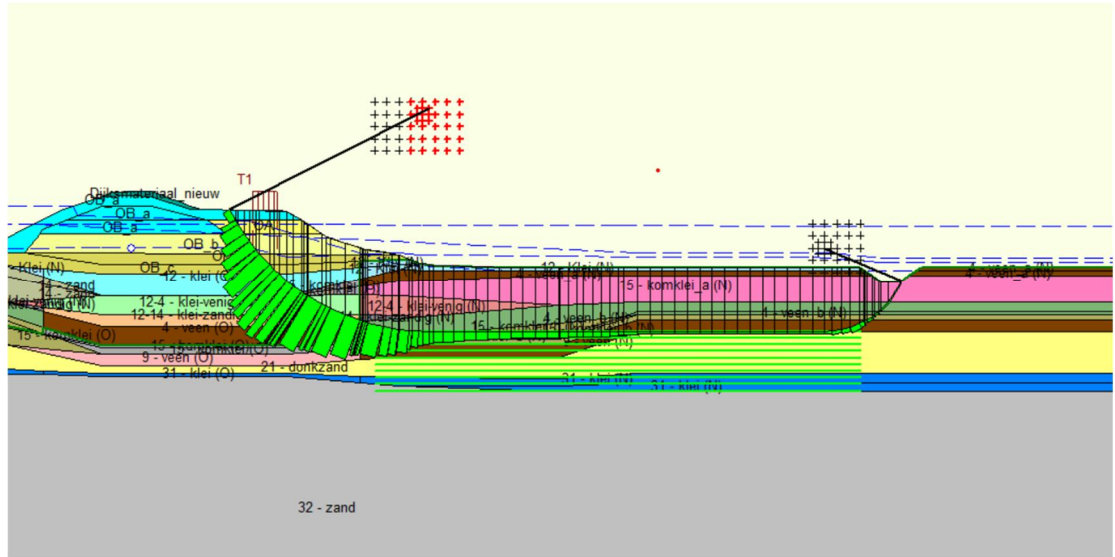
Opdrijven bij groene dijk met stabiliteitsberm (zonder langsconstructie)
